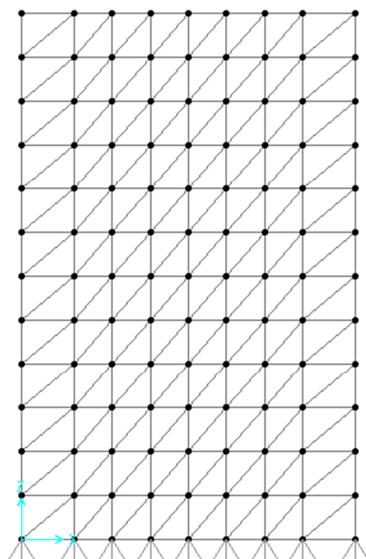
Configuração dos Planos de Contraventamento Vertical Com Elementos de Contraventamento Pequenos
